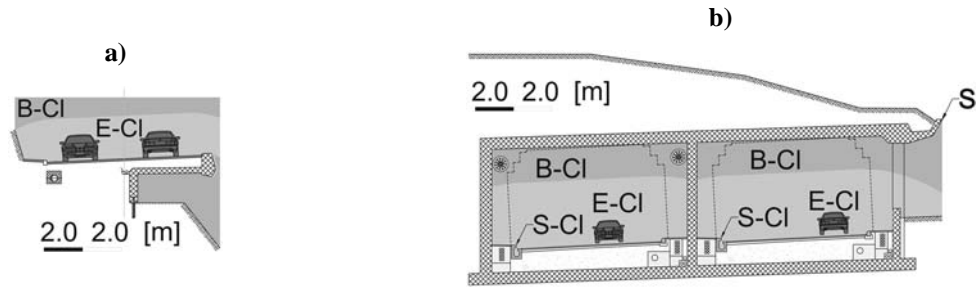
a) Profil type d'un encorbellement sur une route cantonale dans un terrain en pente avec les différentes zones d'exposition pour une vitesse des véhicules à 80 [km/h], plan de base tiré de [Cert04], b) Profil type d'une tranchée couverte et d'une galerie ouverte avec les différentes zones d'exposition pour une vitesse des véhicules à 100 [km/h], plan de base tiré de [Tobola04].
